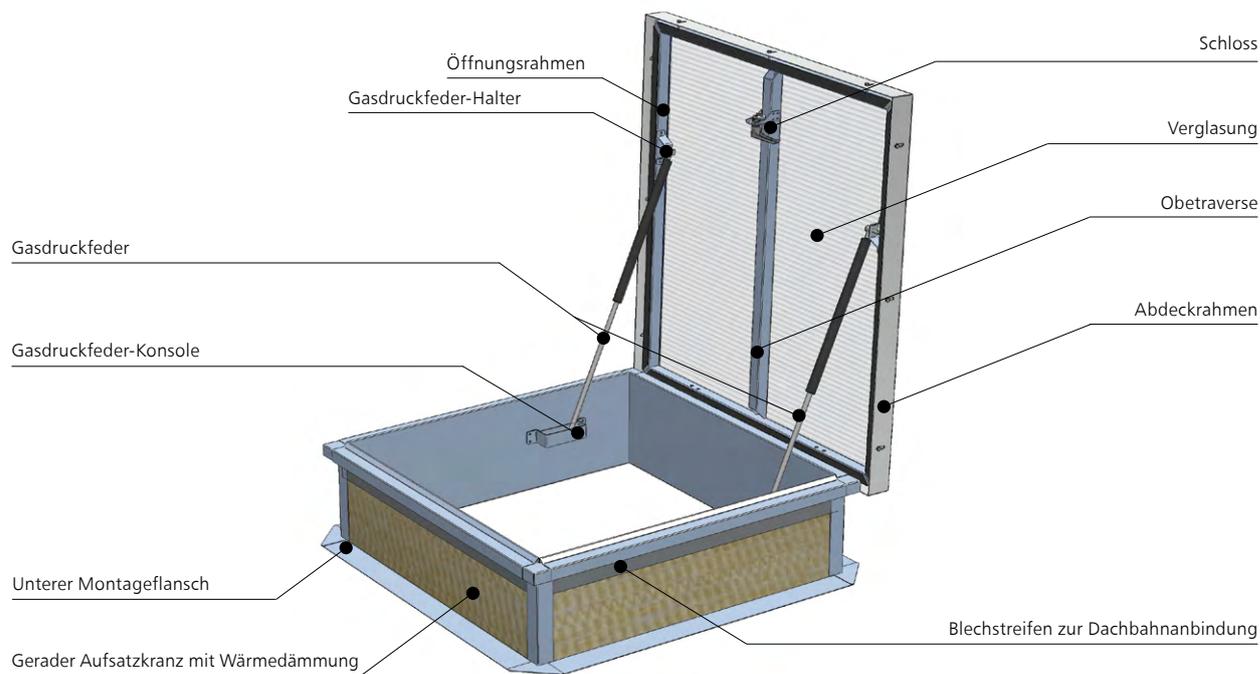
Aufbau eines Dachausstiegs mcr PROLIGHT Typ C
